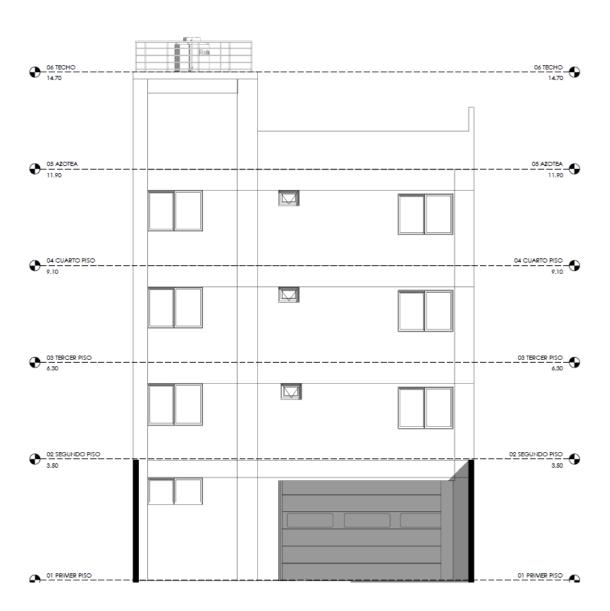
vista de fachada del proyecto desde Jr. Los Planetas
